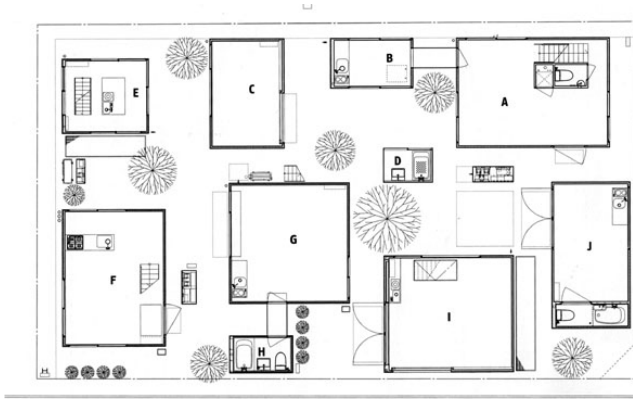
Planta baixa do térreo. Fonte: Gravestmore
